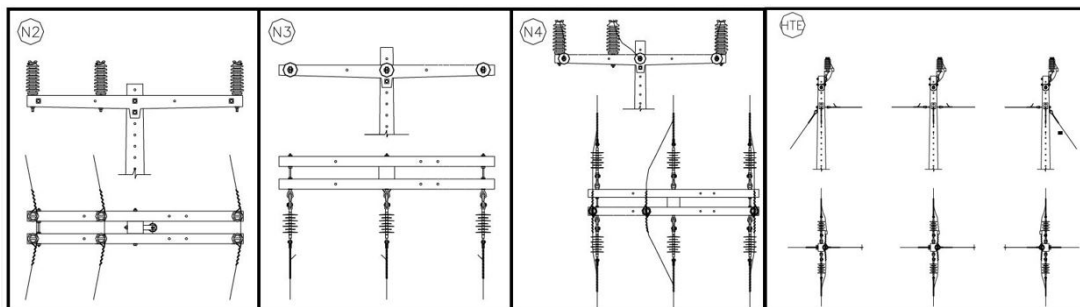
Estruturas utilizadas na construção da rede redundante (ENERGIA, 2023).
